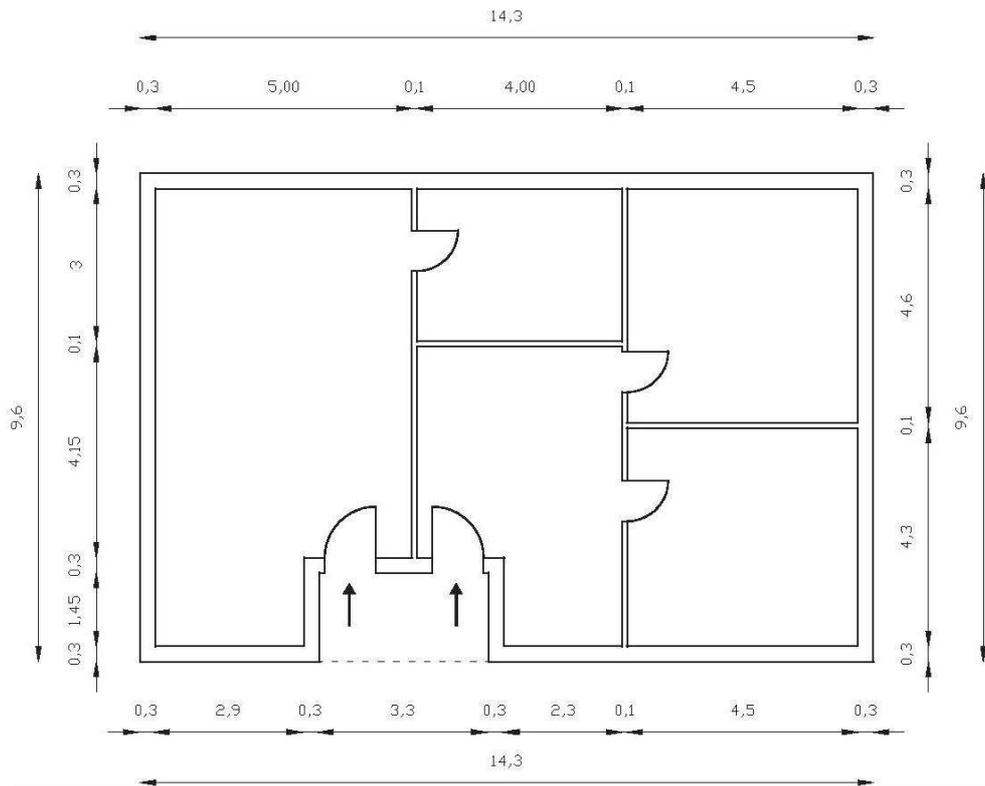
Pianta Centro Recupero e Riparazione AEE
